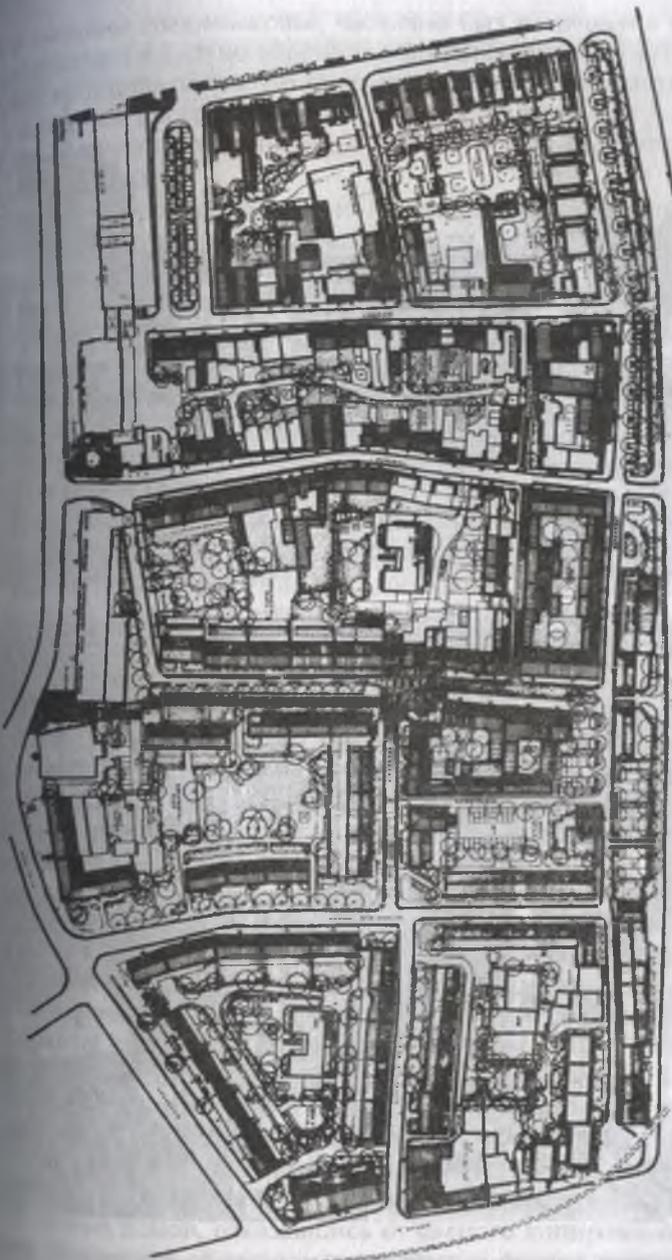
План реконструированного жилого района Старого северного города в г. Росток (Германия)
